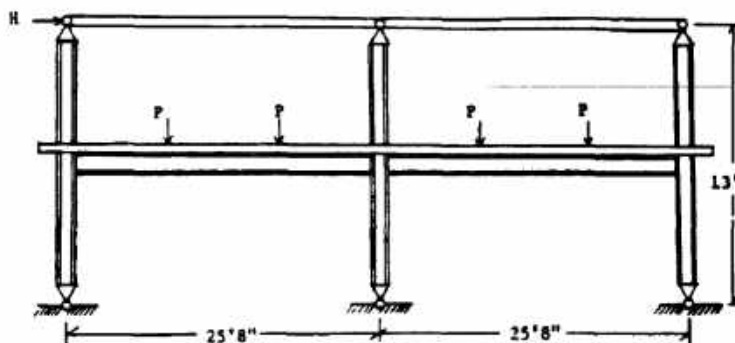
Vista general de espécimen SRCF2C (Ammerman y Leon 1987)
